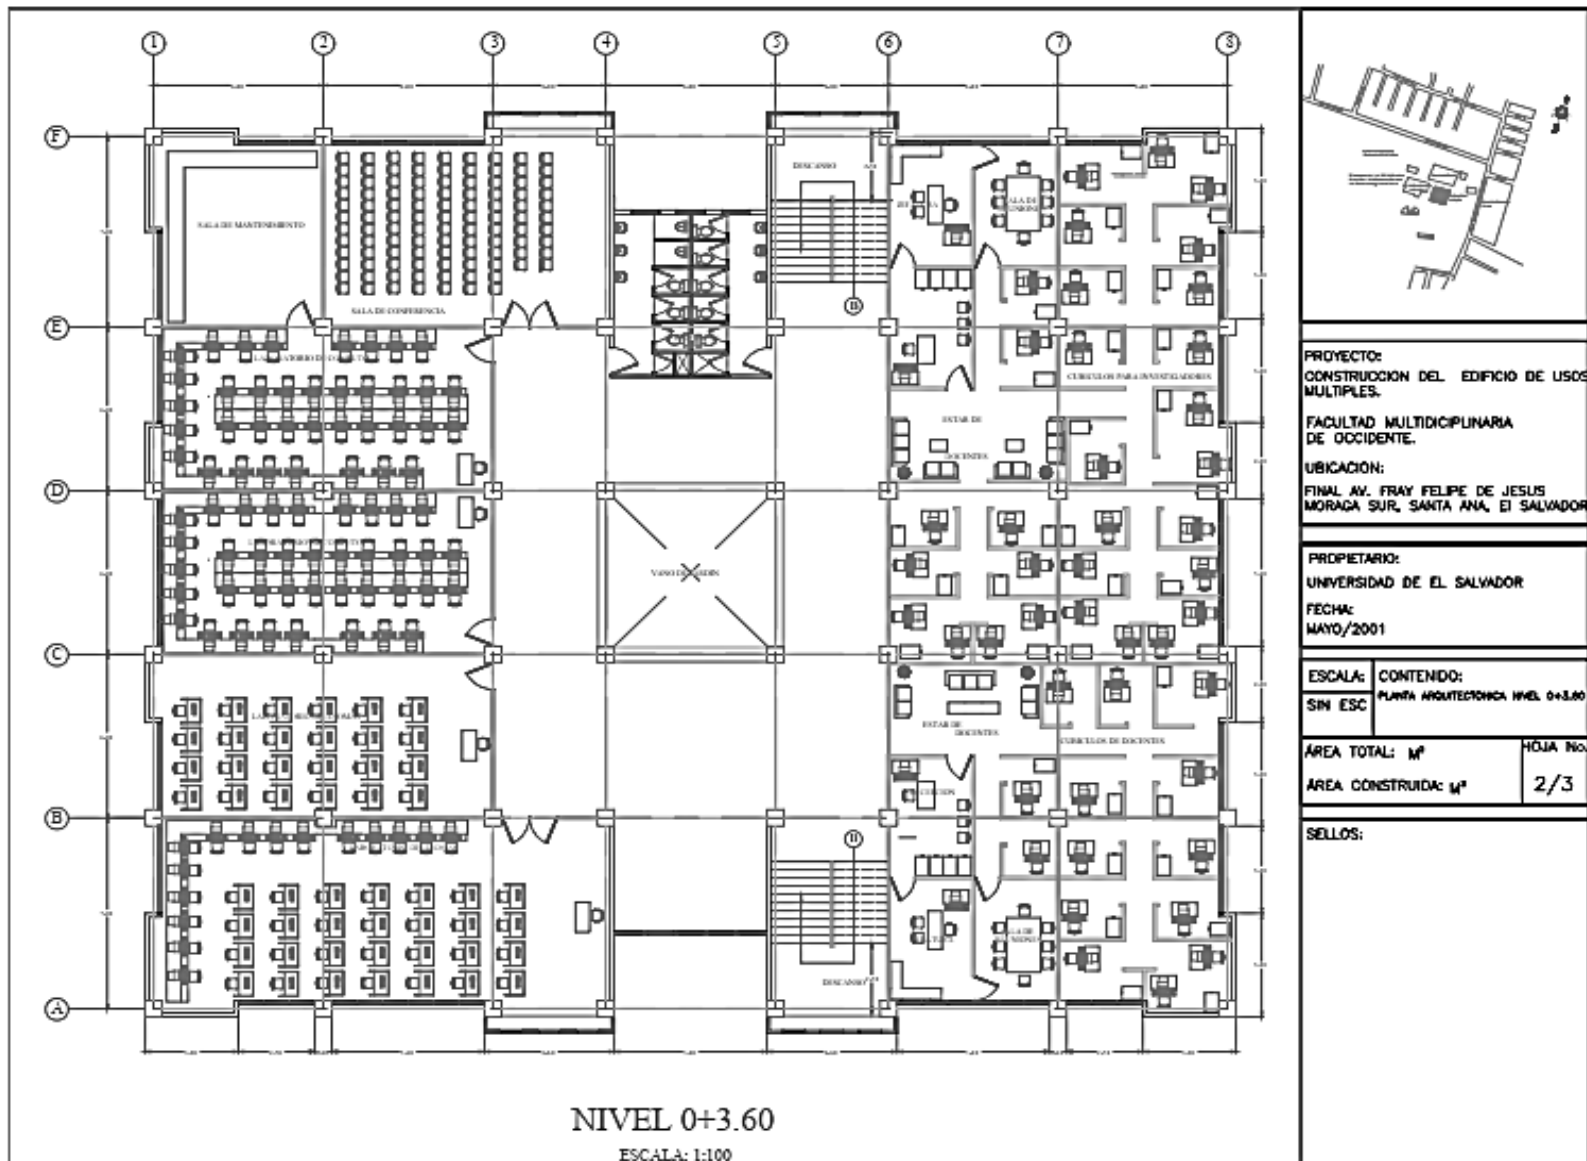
Planta Arquitectónica Nivel 0+3.60 del edificio en evaluación
